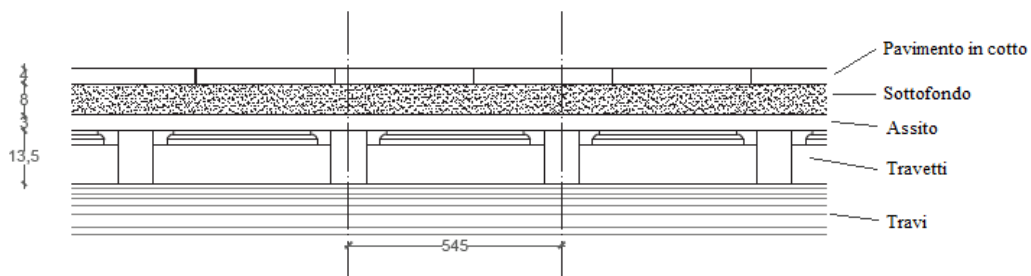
Schema della sezione del solaio nella direzione delle travi
